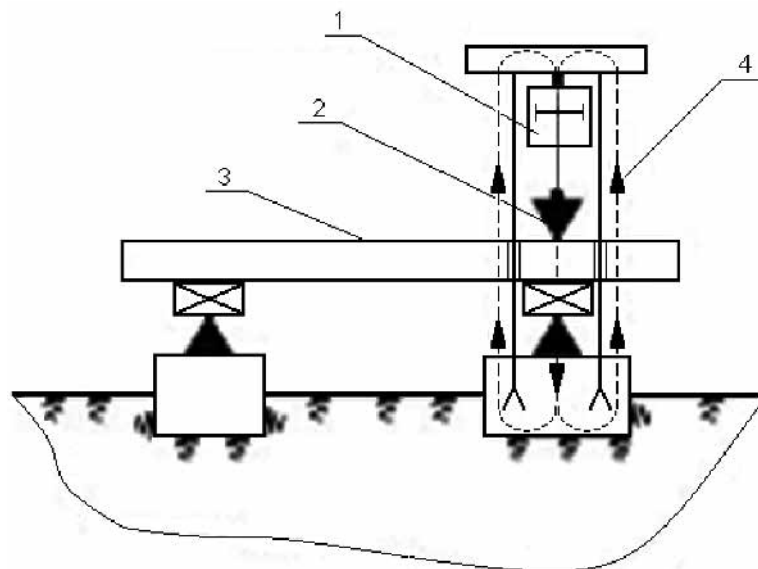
Потік навантажувальних зусиль на вагову платформу і конструкцію фундаменту, створених гідроциліндрами, розміщеними на ваговій платформі
